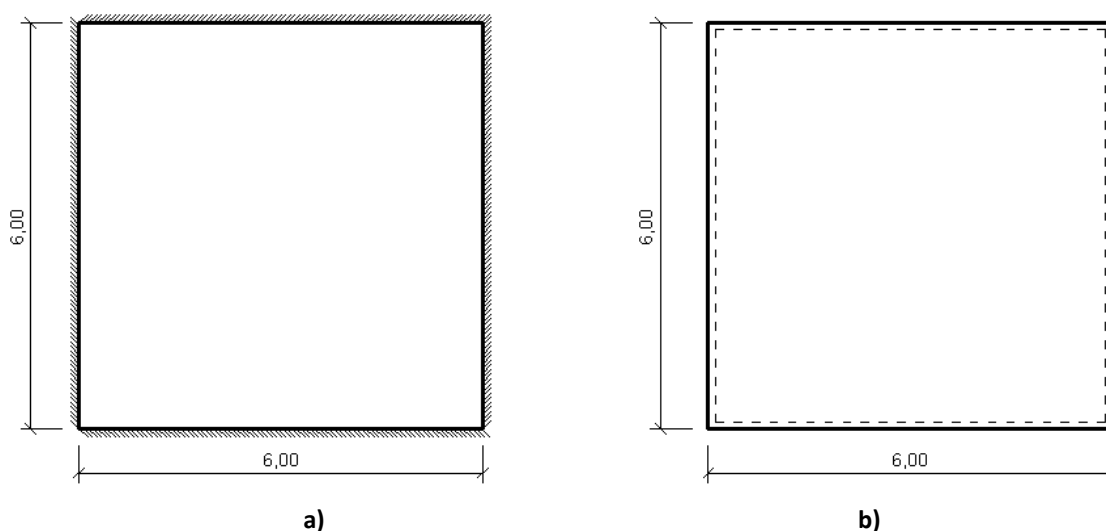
Representação da Laje utilizada na validação do programa (dimensões em metros). a) laje encastrada, b) laje apoiada.
